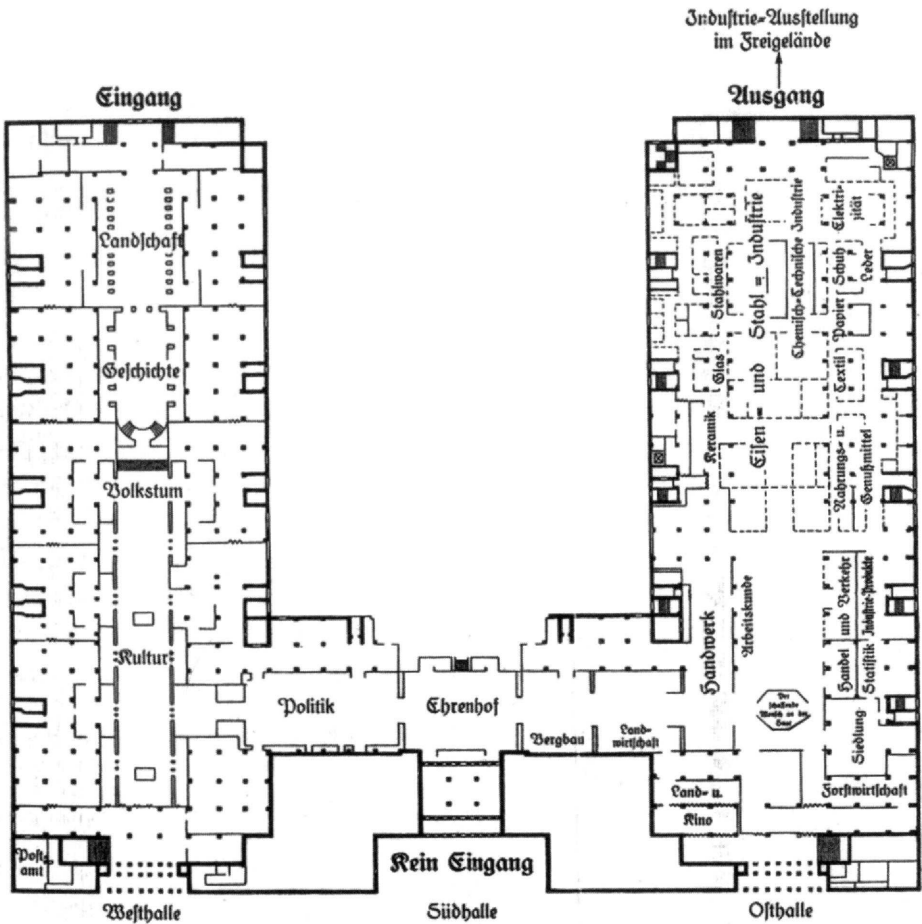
Grundriss der großen Kölner Ausstellung „Die deutsche Saar“, 26.8.-15.9.1934
